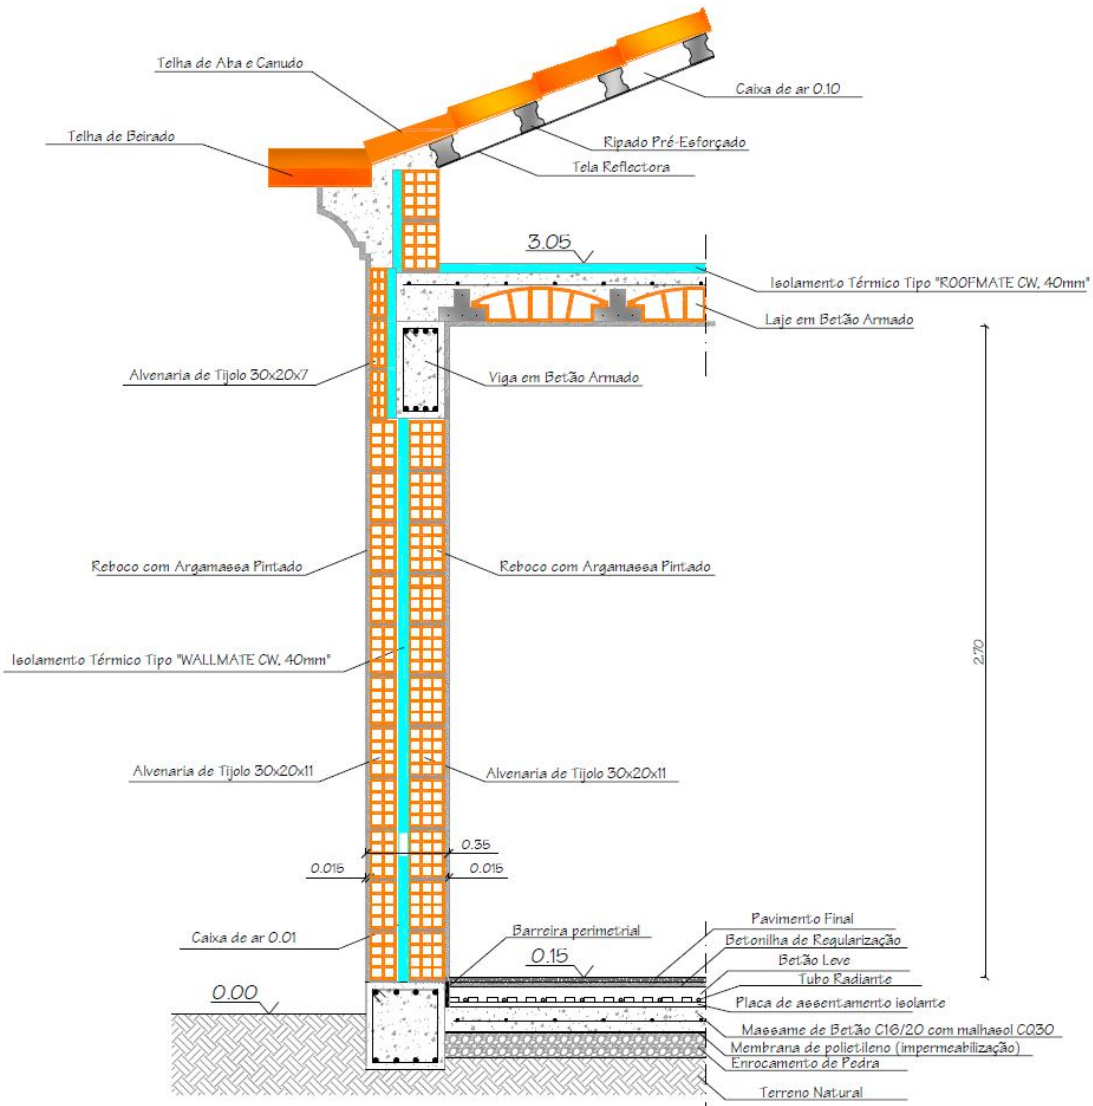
Pormenor do corte geral na fachada da moradia
